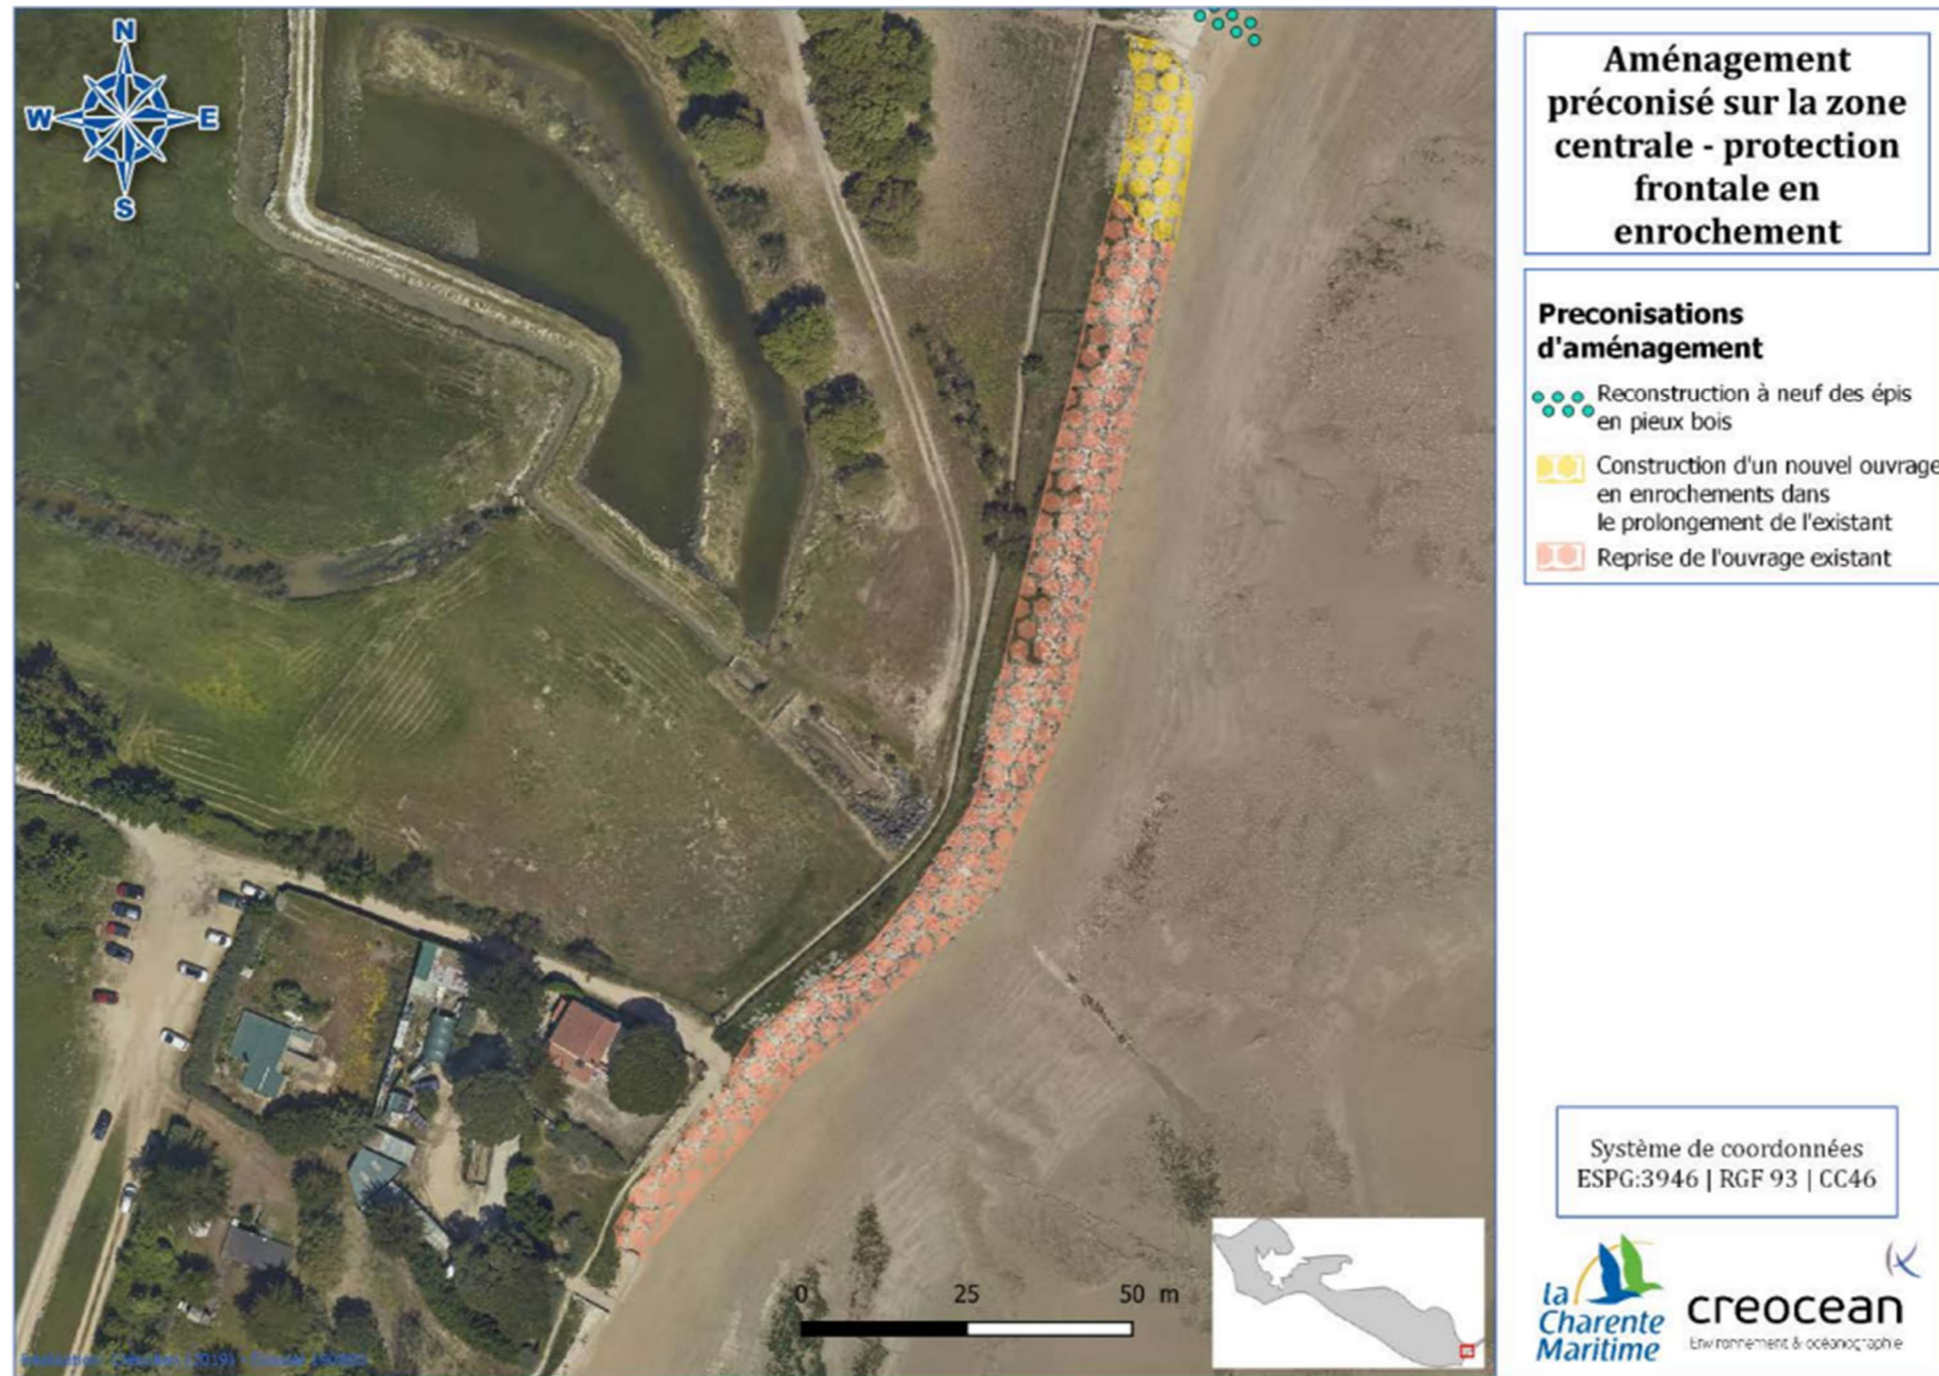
Plan d'aménagement – enrochements – du projet « 3. Système de protection de côte du virage du défend »
